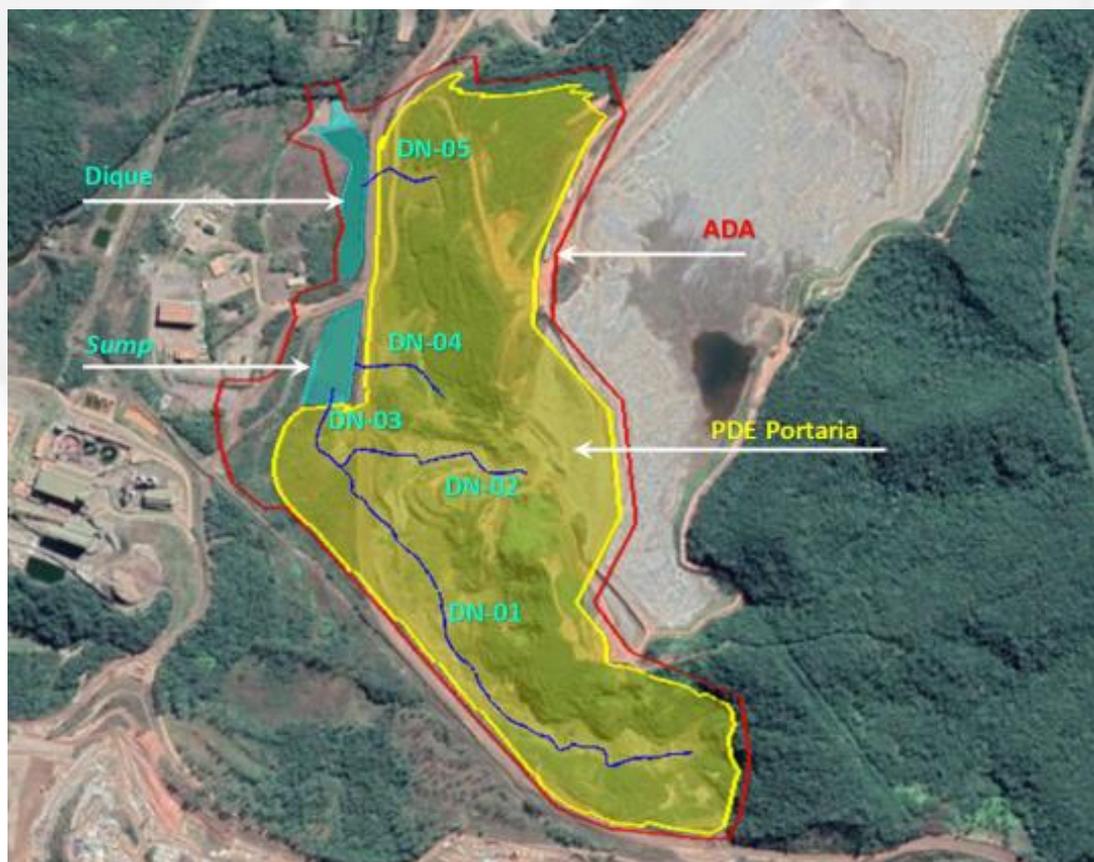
Estruturas de Drenagem da PDE Portaria
